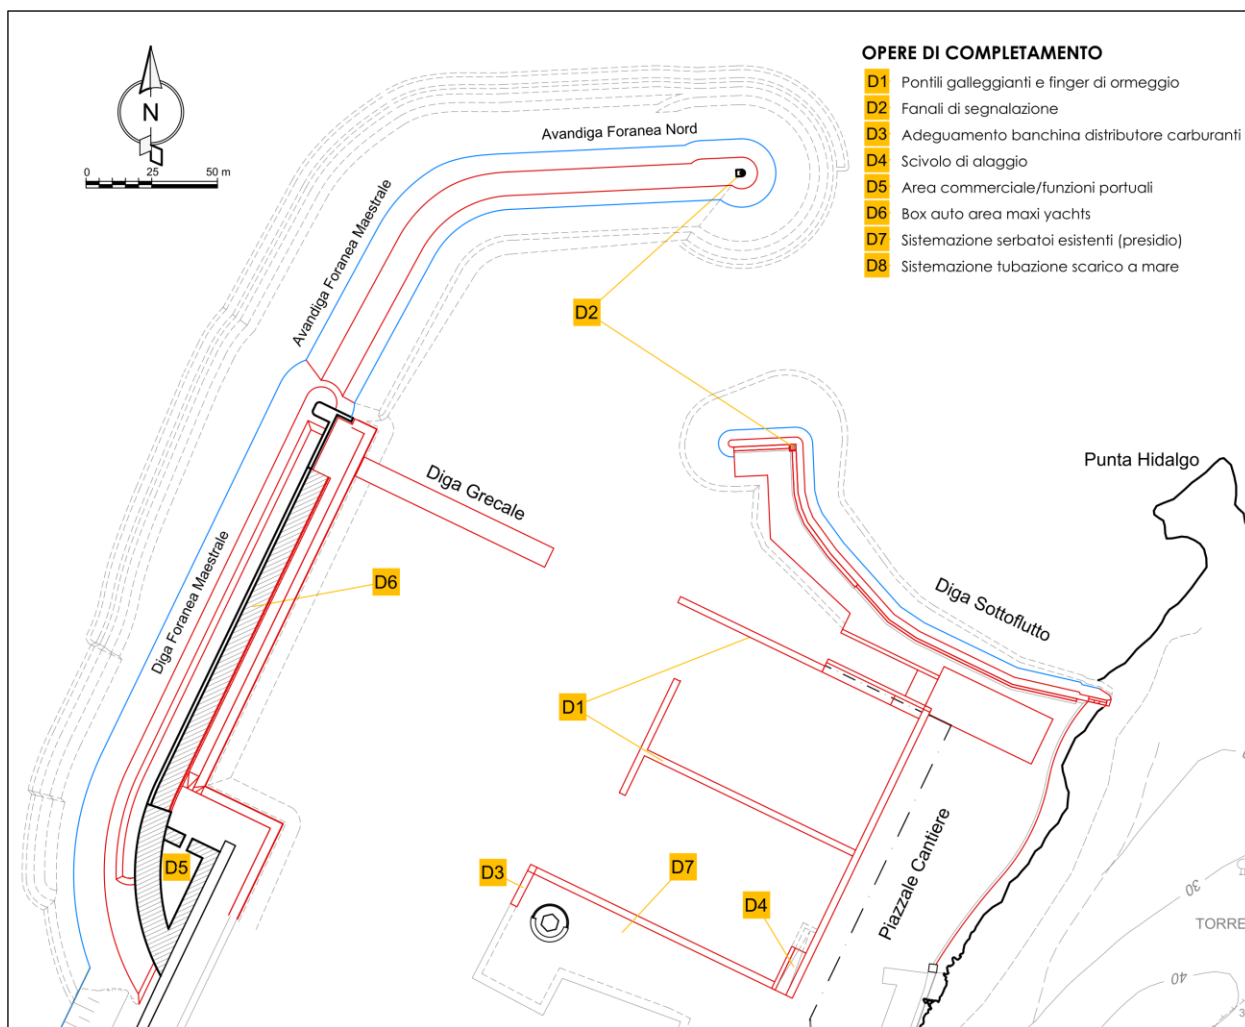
Indicazione delle opere di completamento previste da progetto
